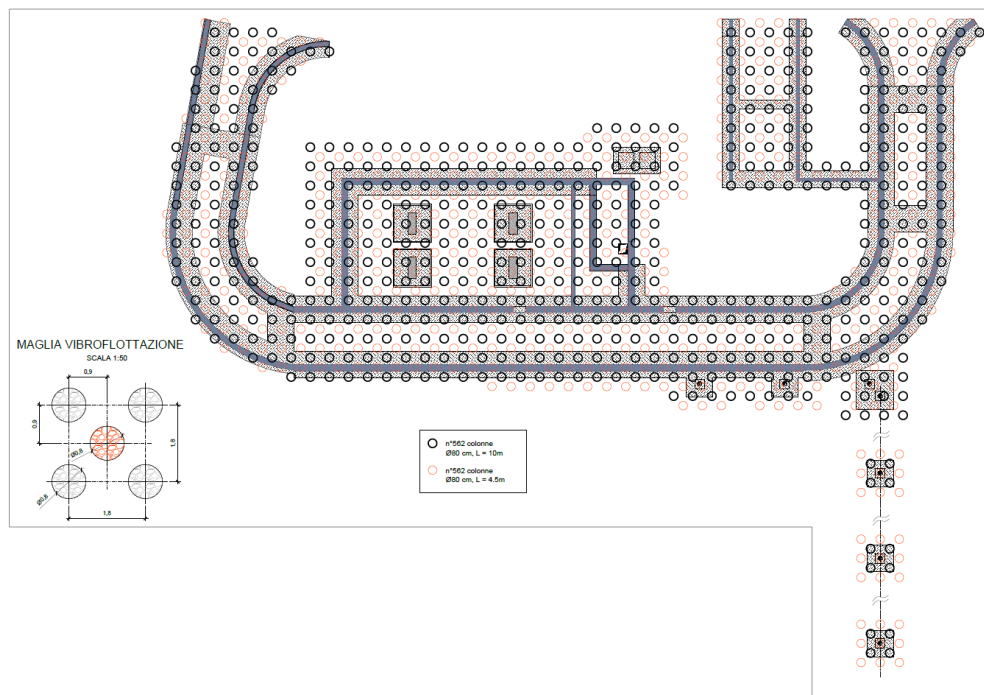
C.le di Porto Corsini - Planimetria dell'intervento di vibroflottazione.
